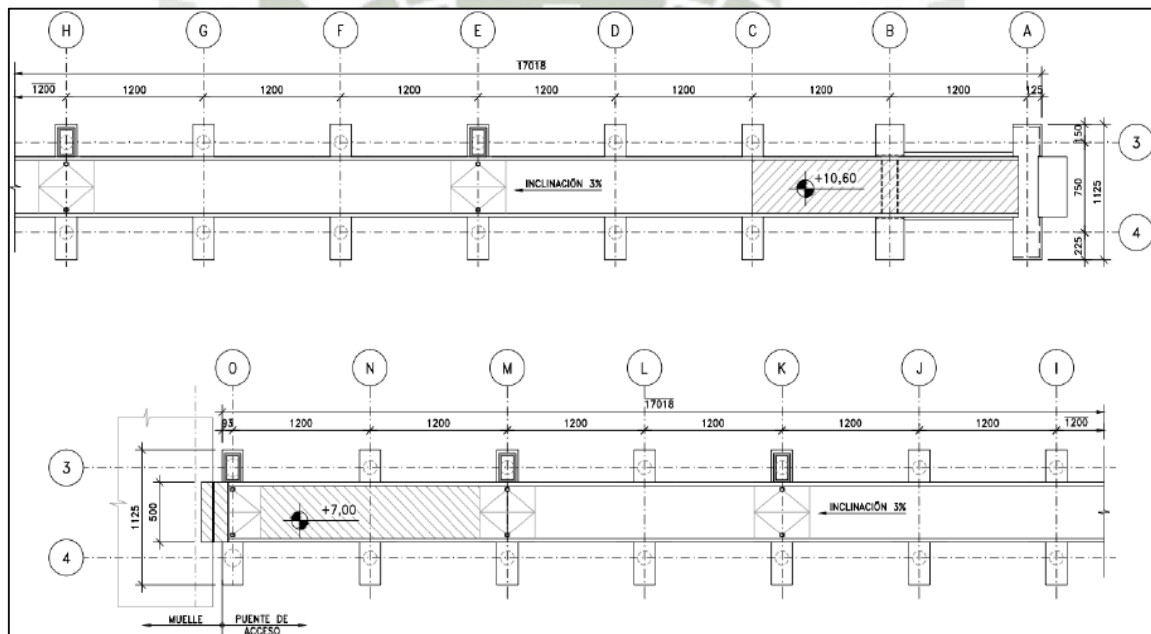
Planta General del Puente de acceso (Proyecto Matarani, 2013)
